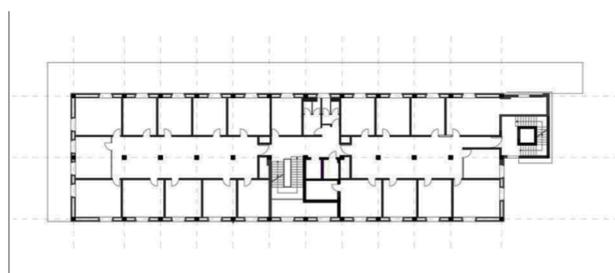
Pianta di un piano tipo dell'edificio dopo l'intervento.
